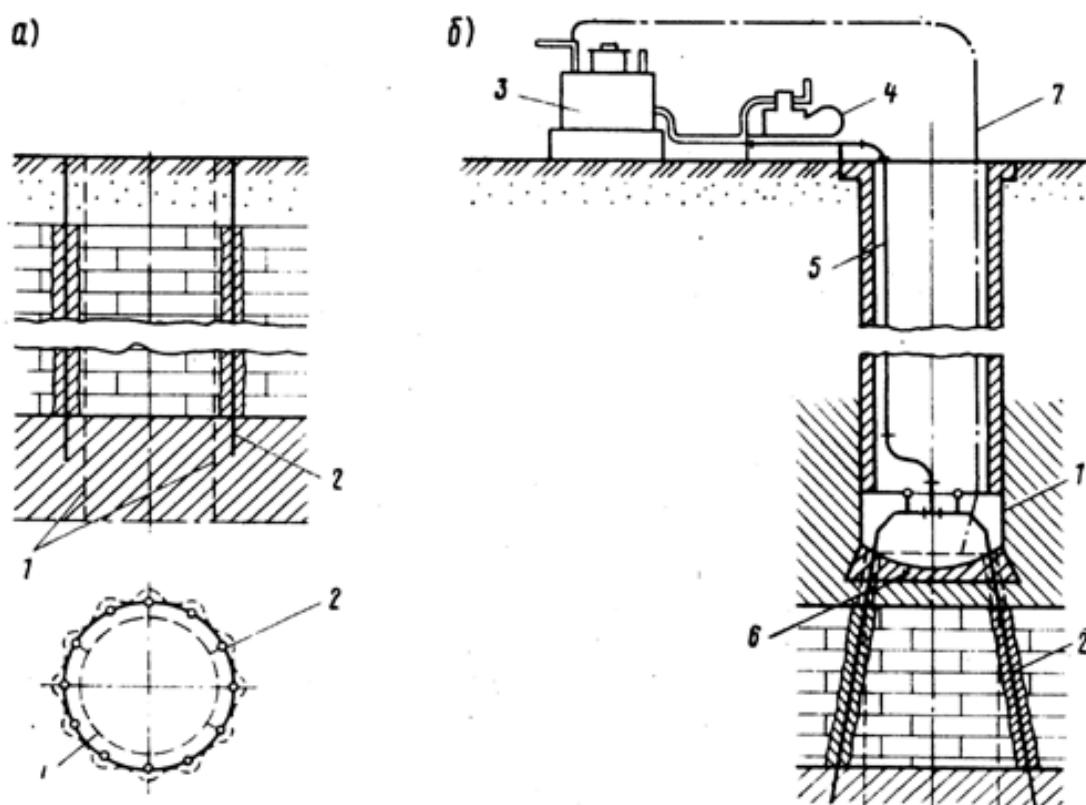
Схема цементации грунтов перед проходкой ствола шахты:
